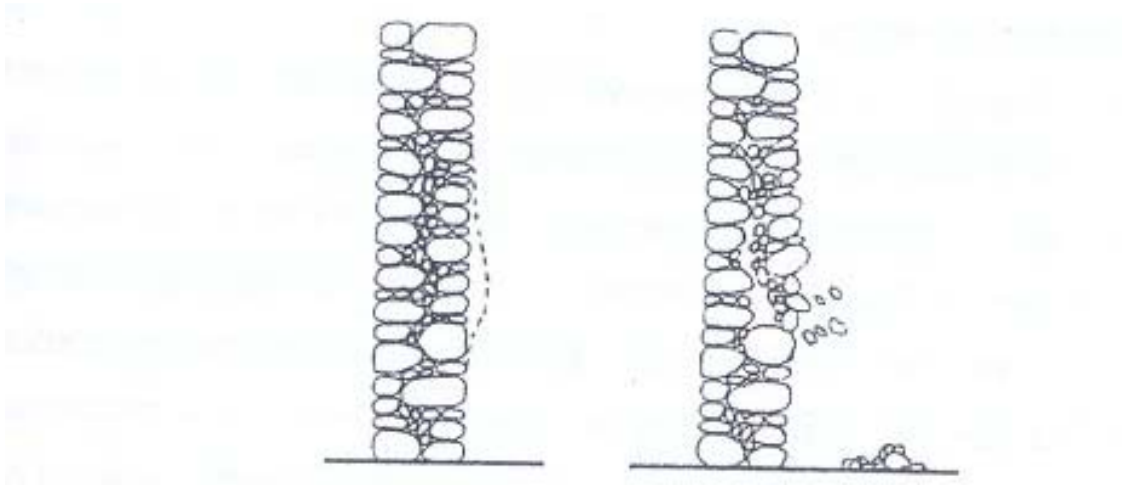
Instabilização local de uma parede de pedra com fraca ligação transversal entre paramentos [Giuffrè, 1993].
